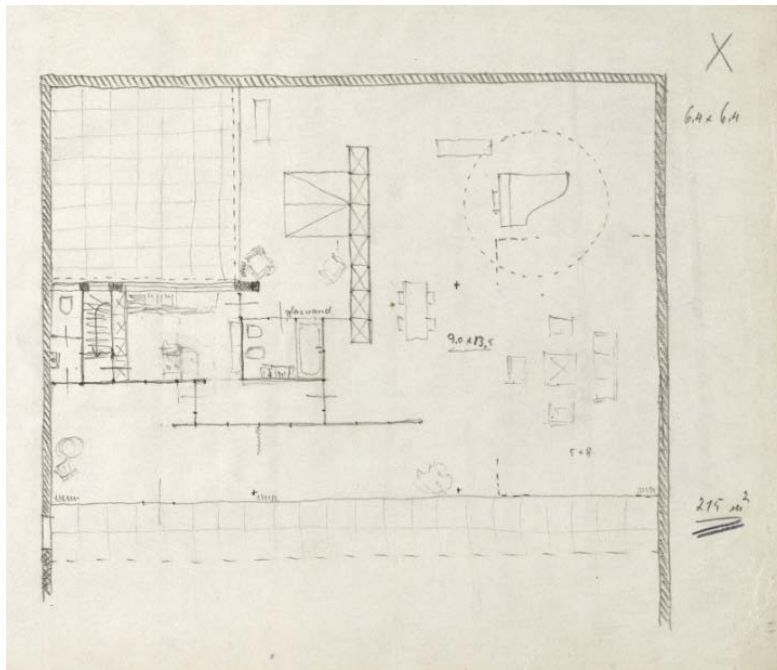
Estudo em planta baixa, Casa Hubbe, 1934.
